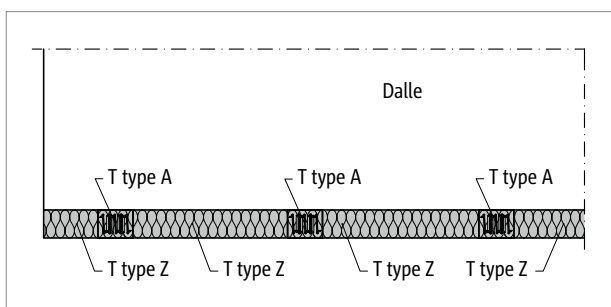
Schöck Isokorb® T type A disposition verticale : projection horizontale avec garde-corps posé au-dessus
